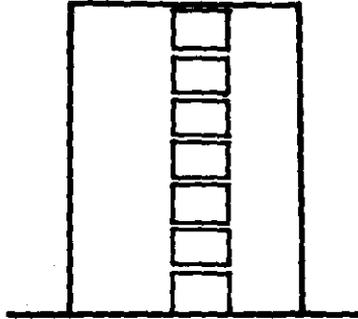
Sistemas de muros acoplados (Cap.4,Ref.3)
